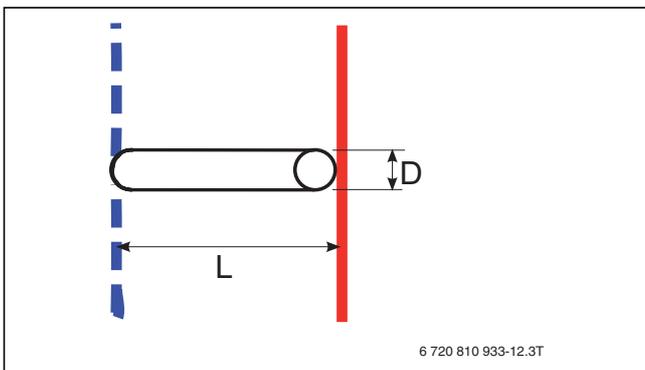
Bypass Detailansicht (→ [1] Abb. 2 und 3)
